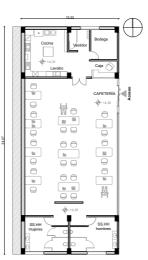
Bloque 3 - planta baja ESC_1:400 Elaborado por: Autor
